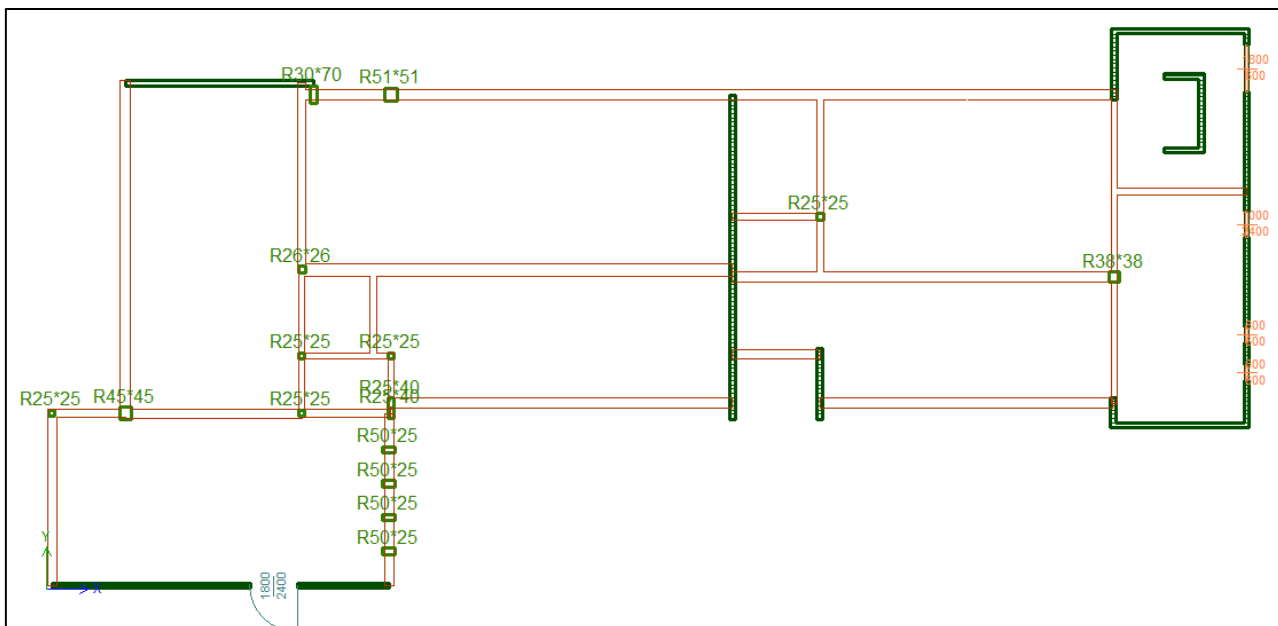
Pré-dimensionnement des poteaux du RDC, Tranche 2.
